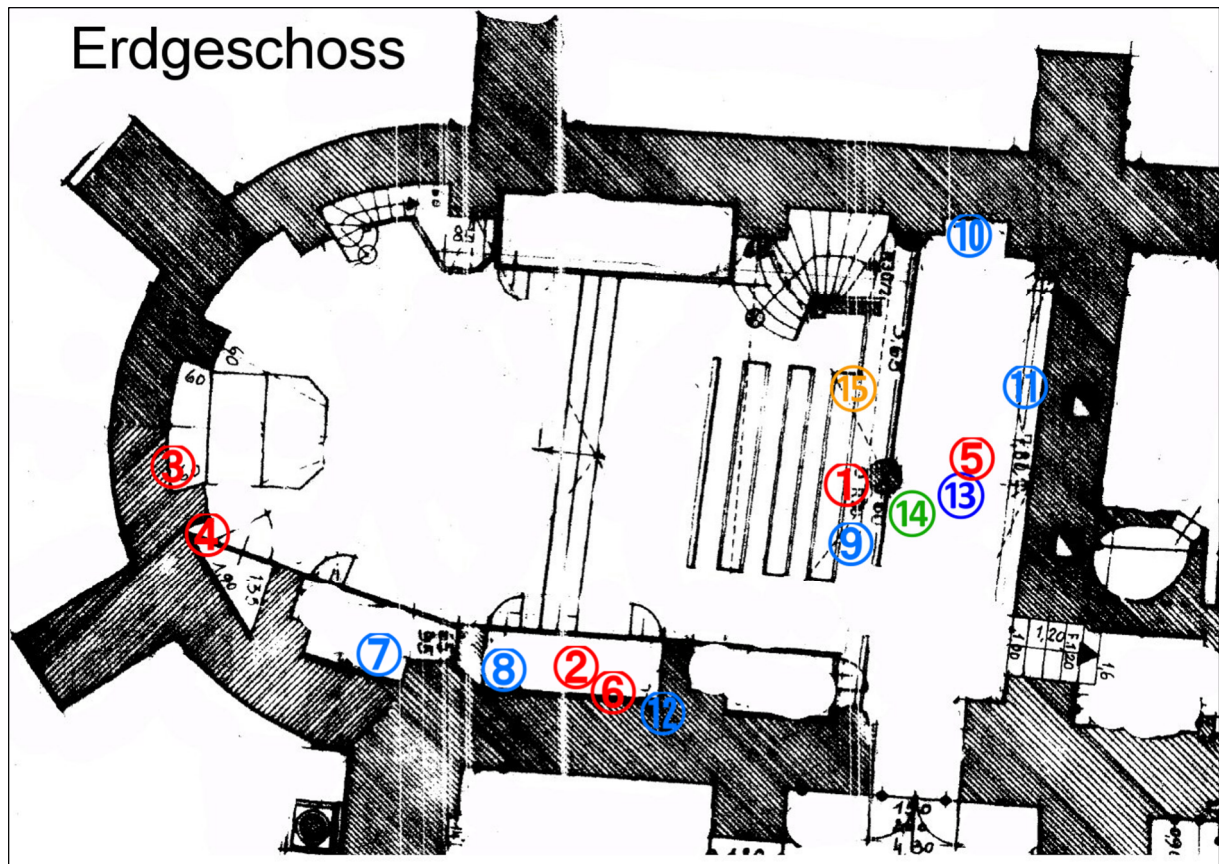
Grundriss der Schlosskapelle mit Messorten
